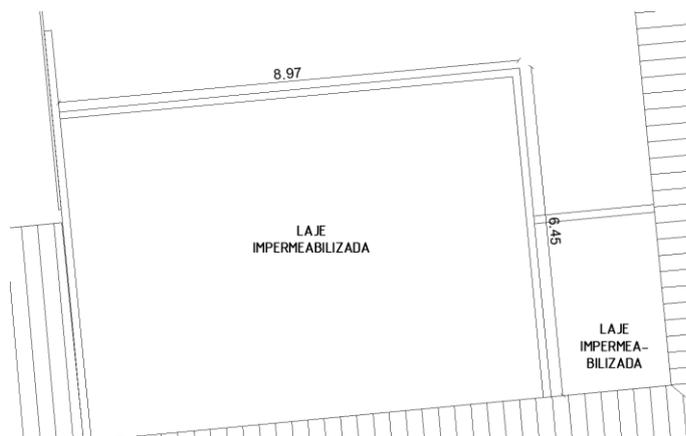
Situação modificada no setor de garagem coberta - Projeto SCI.
